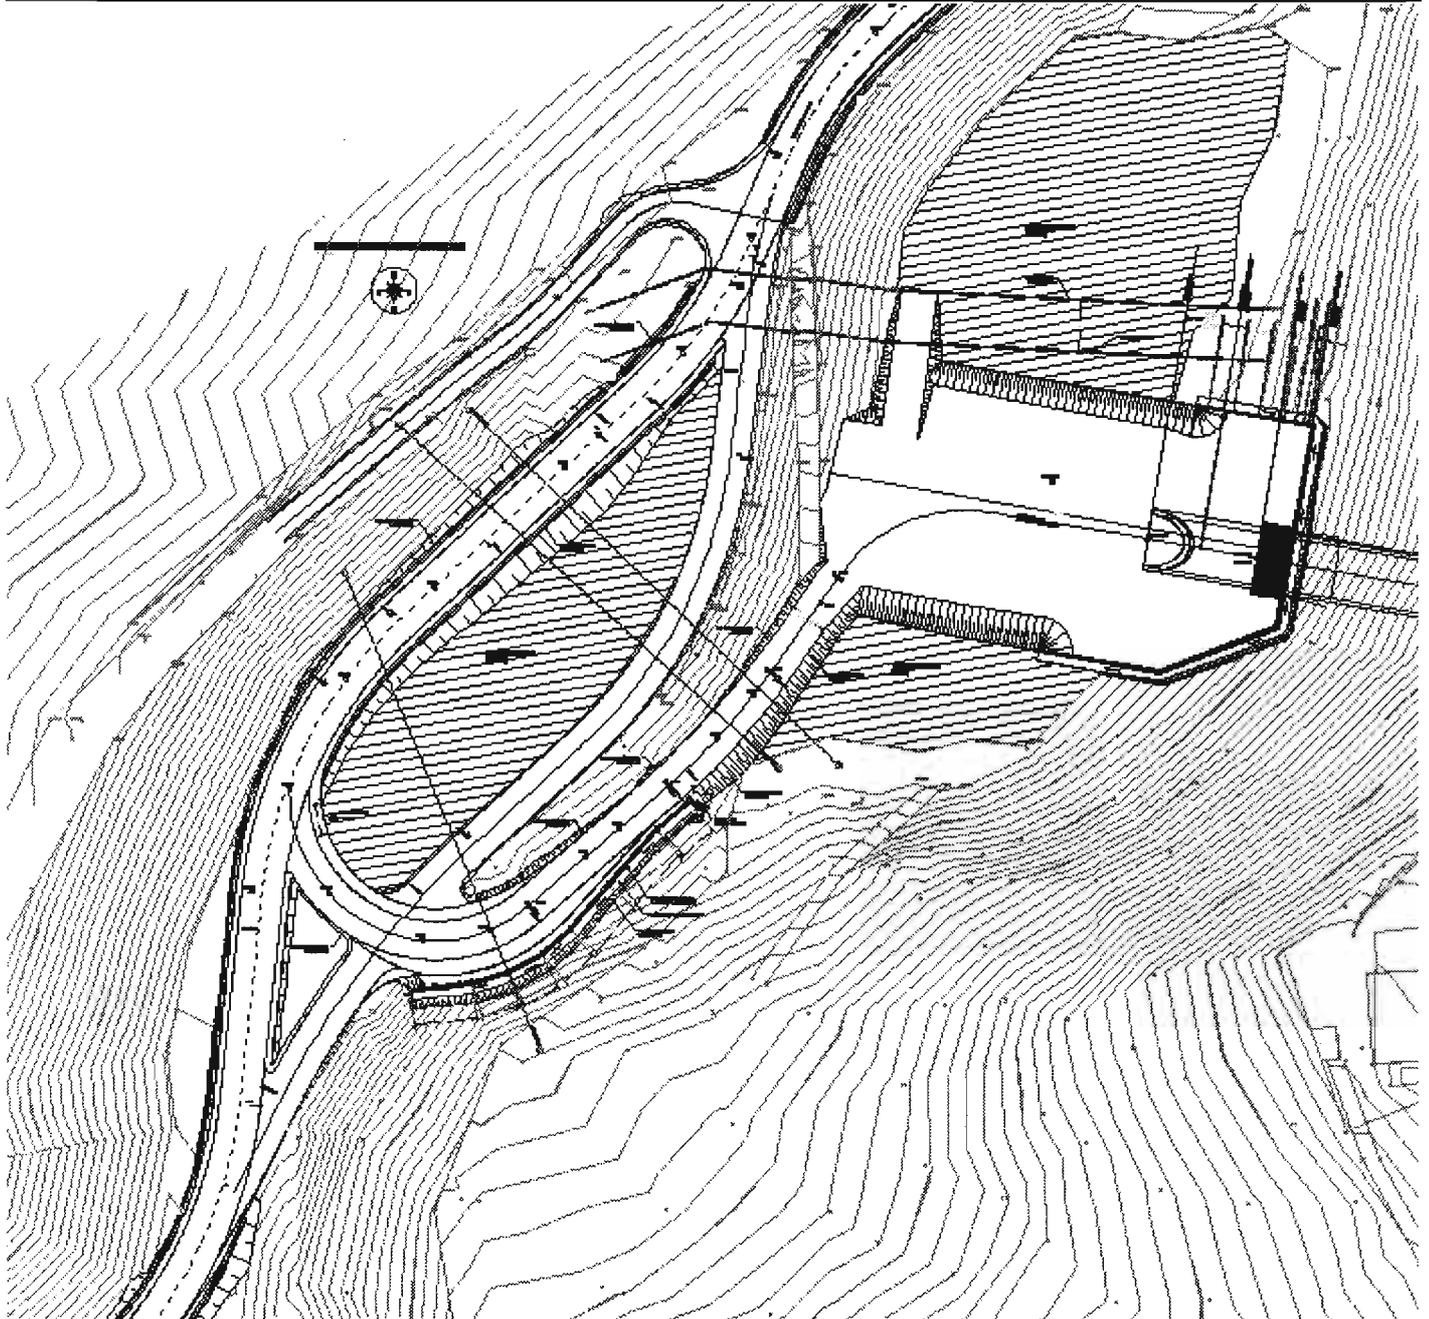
Schema planimetrico Cantierizzazione Chiusa Fase Definitiva
